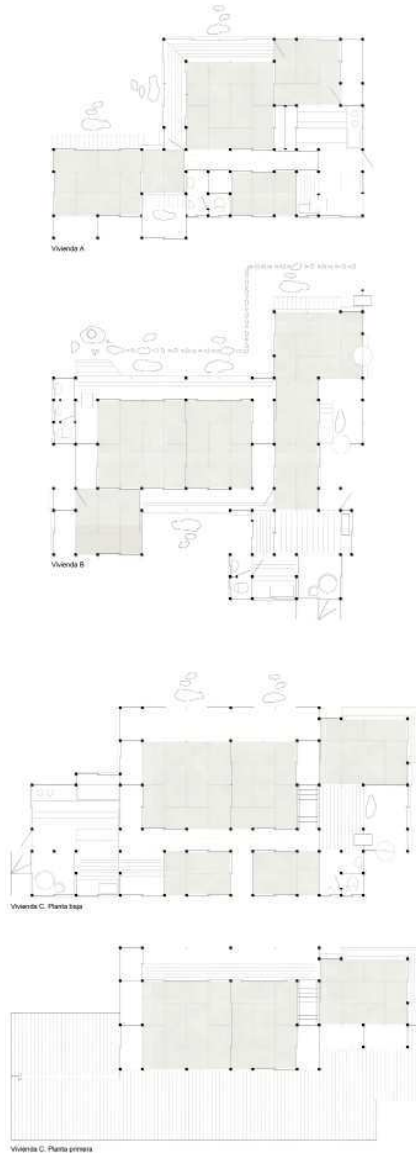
Figura de autor. Plantas tipo. Sistema constructivo y compositivo basado en el pilar.
